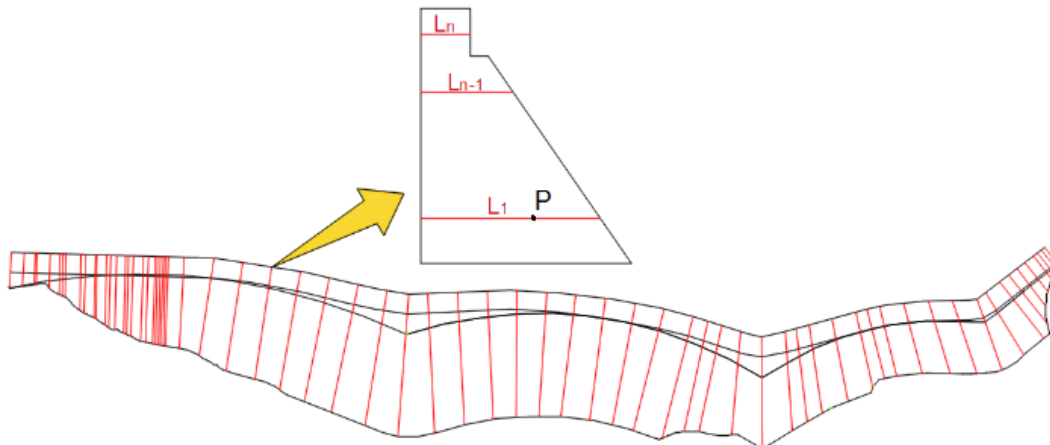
Planta das secções transversais em que a barragem foi discretizada.
